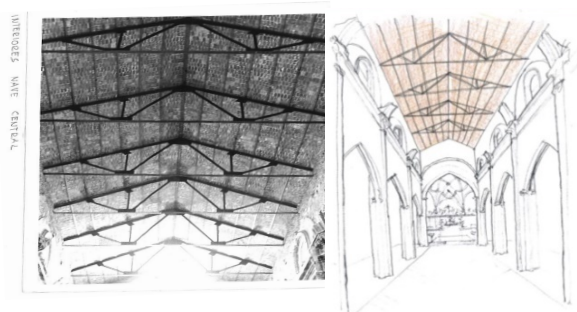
Nueva cubierta realizada en 1970-75 Arquitecto José A Gómez Luengo. Foto y croquis del autor
